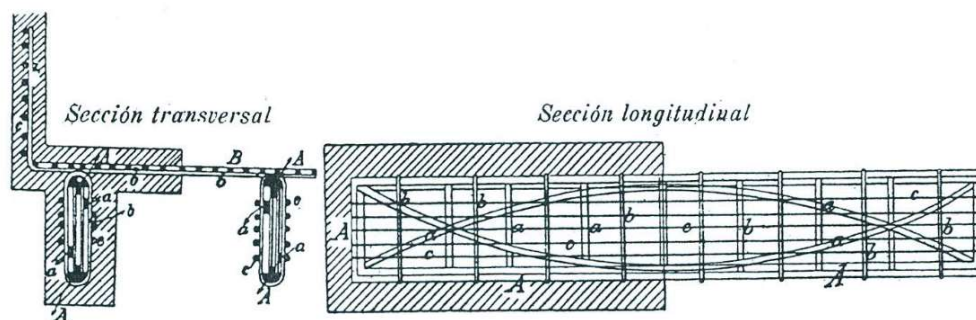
La patente de Monier para vigas de hormigón armado. Imagen del libro *Teoría y Práctica del Hormigón Armado* de E. Mörsch.<sup>209</sup>
